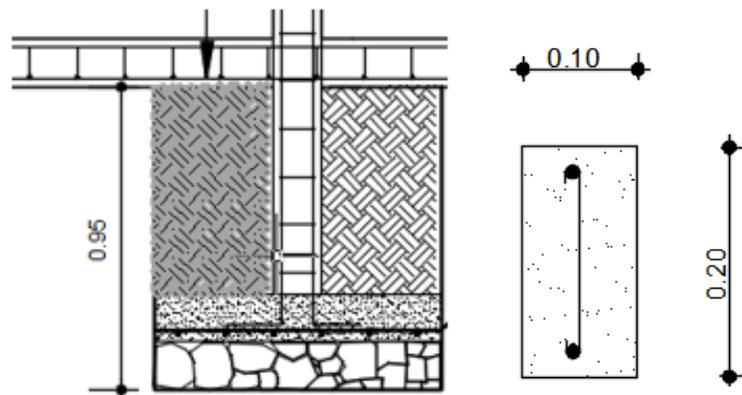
Elevación plinto, sección viga de cimentación vivienda MIDUVI año 2012.
